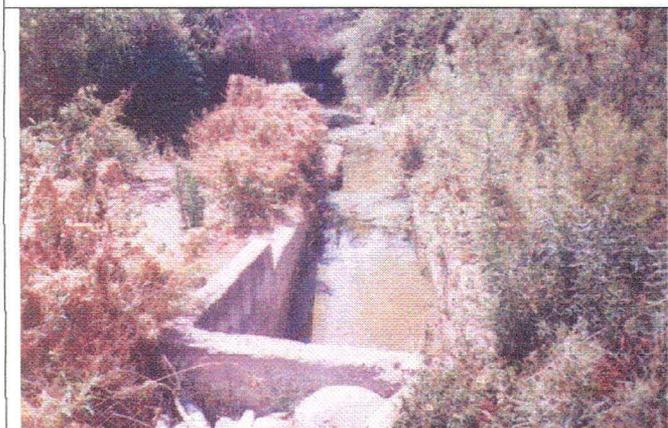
Entrada Sifón. Estructura de hormigón en paso del canal por estero La Patagua.
